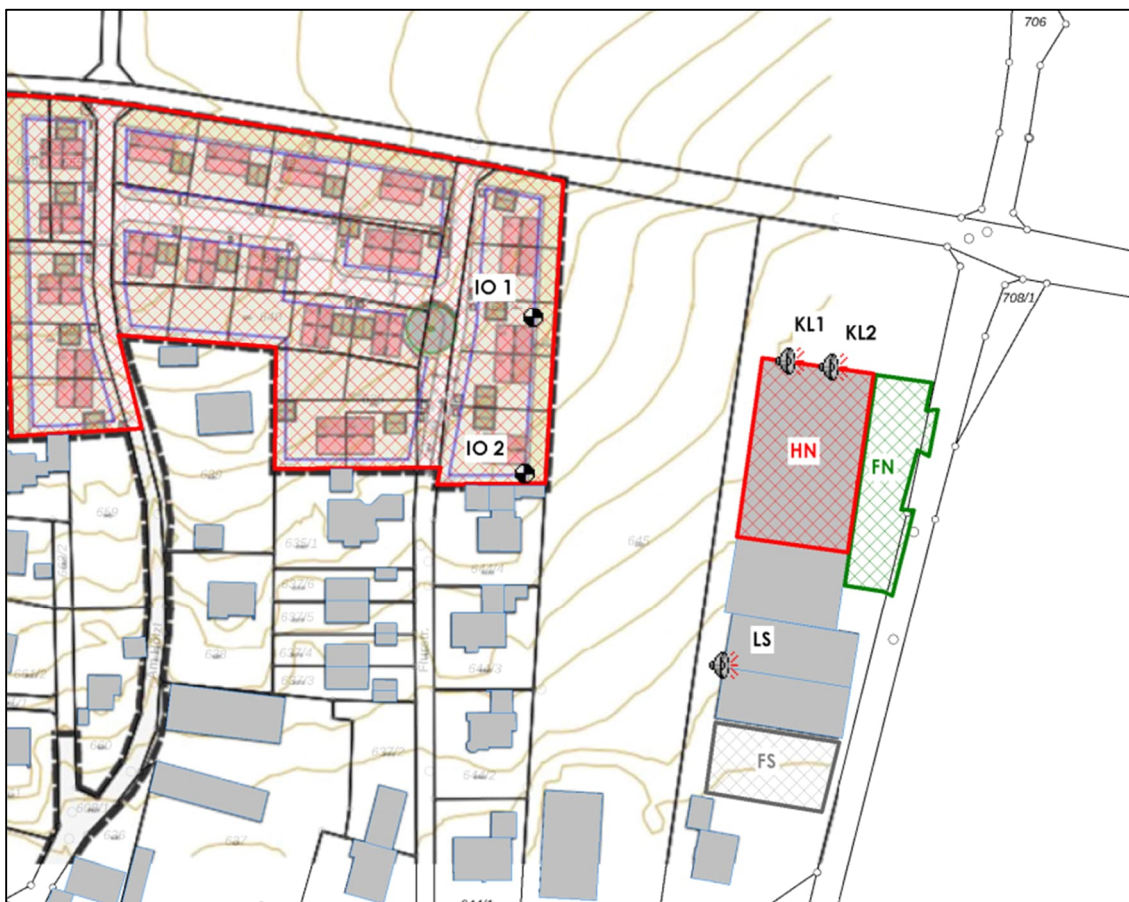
Lageplan mit Darstellung der Schallquellen und der exemplarischen Immissionsorte
